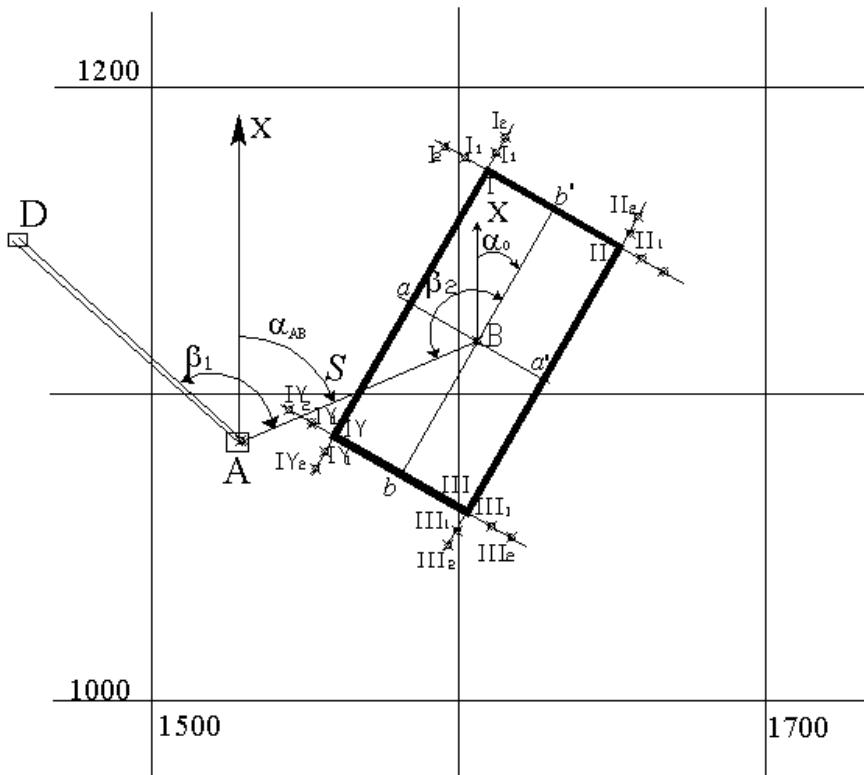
Пояснительная схема к проекту разбивки здания на промышленной площадке карьера.
